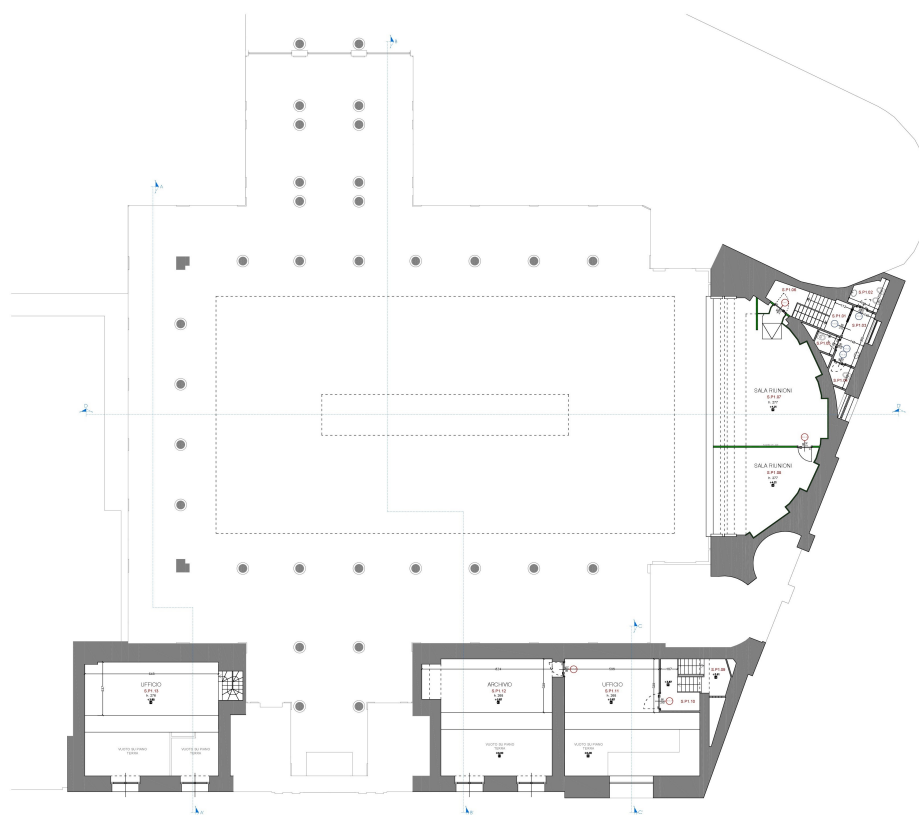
Planimetria dello Stato di Fatto - livello soppalchi
